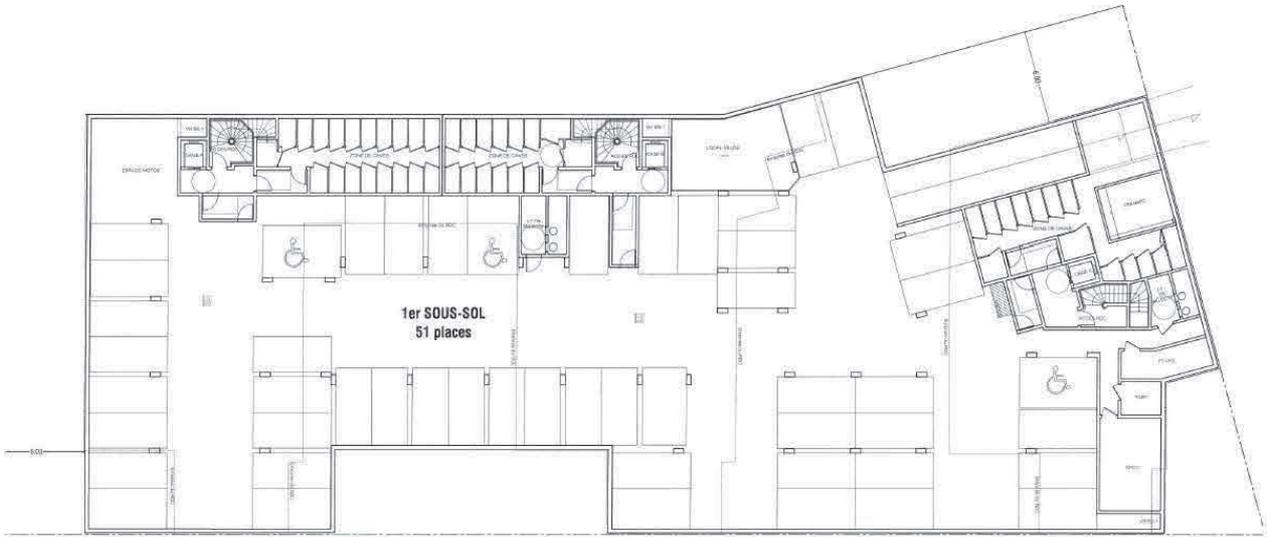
Plan du sous-sol du Lot B1A1 (Source : International d'Architecture)
